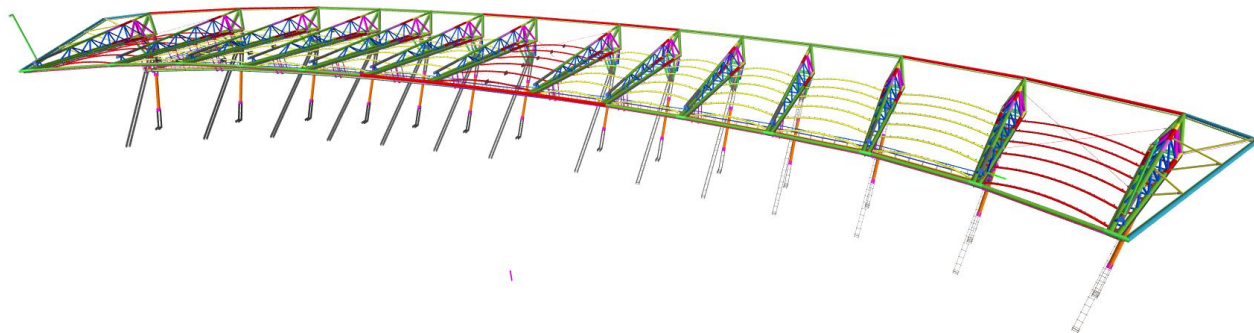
Vista del modelo tridimensional de la estructura metálica de la cubierta.
